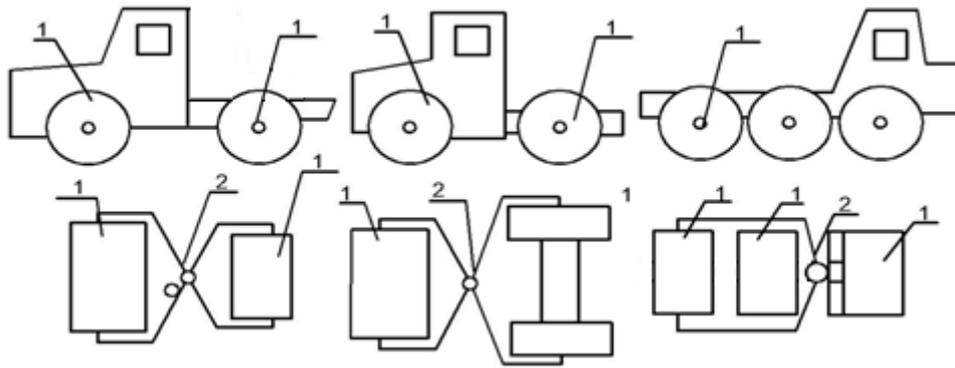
Катки с гладкими вальцами – вид и кинематическая схема:
